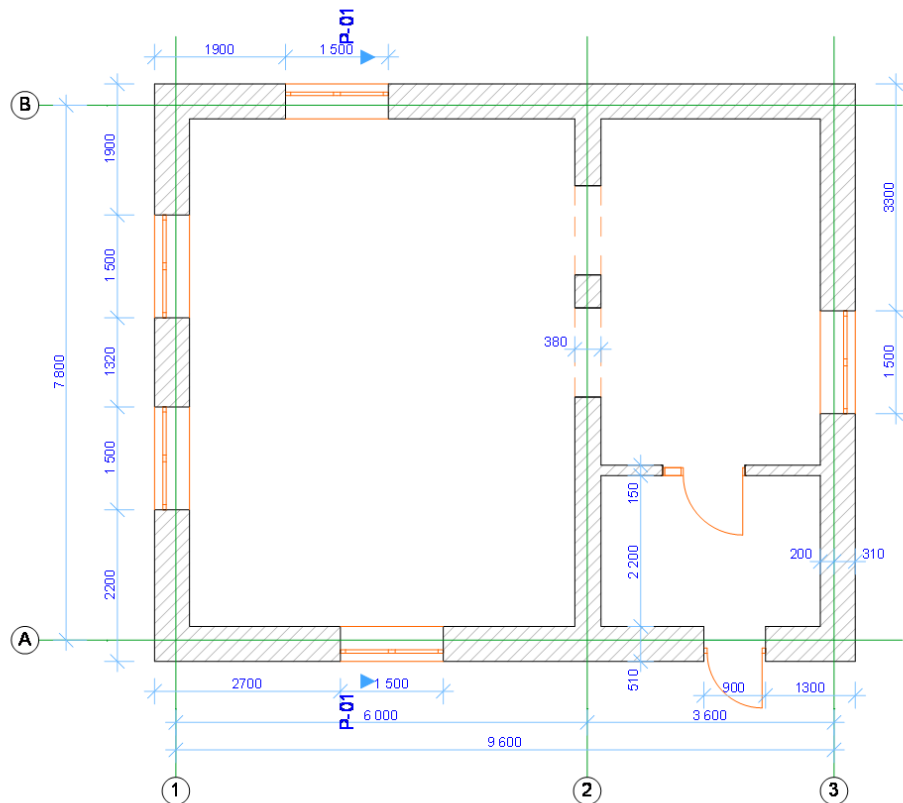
План первого этажа с осями, размерами и разрезом.
